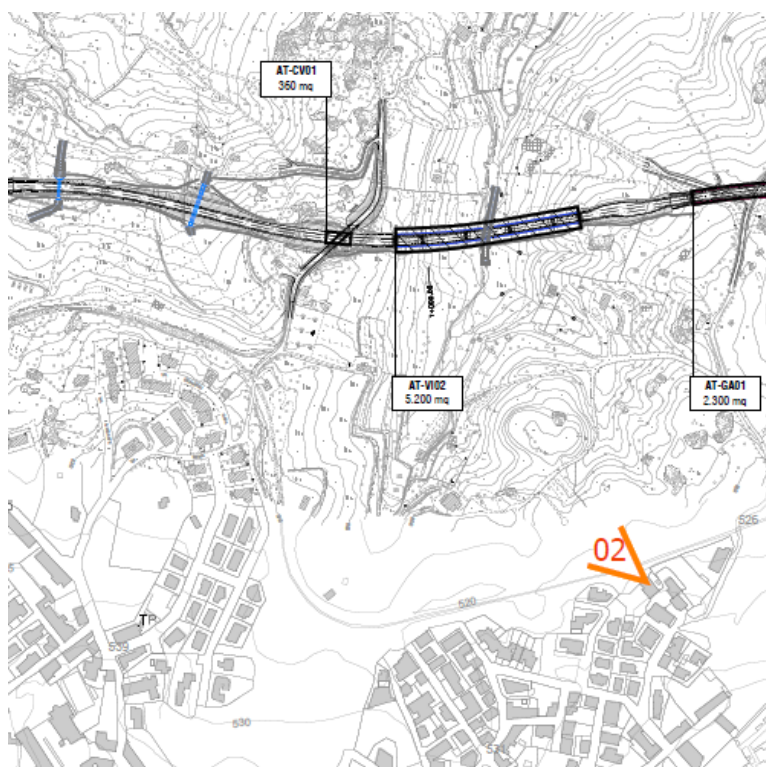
Stralcio con localizzazione del cono visuale rispetto al tracciato di progetto
